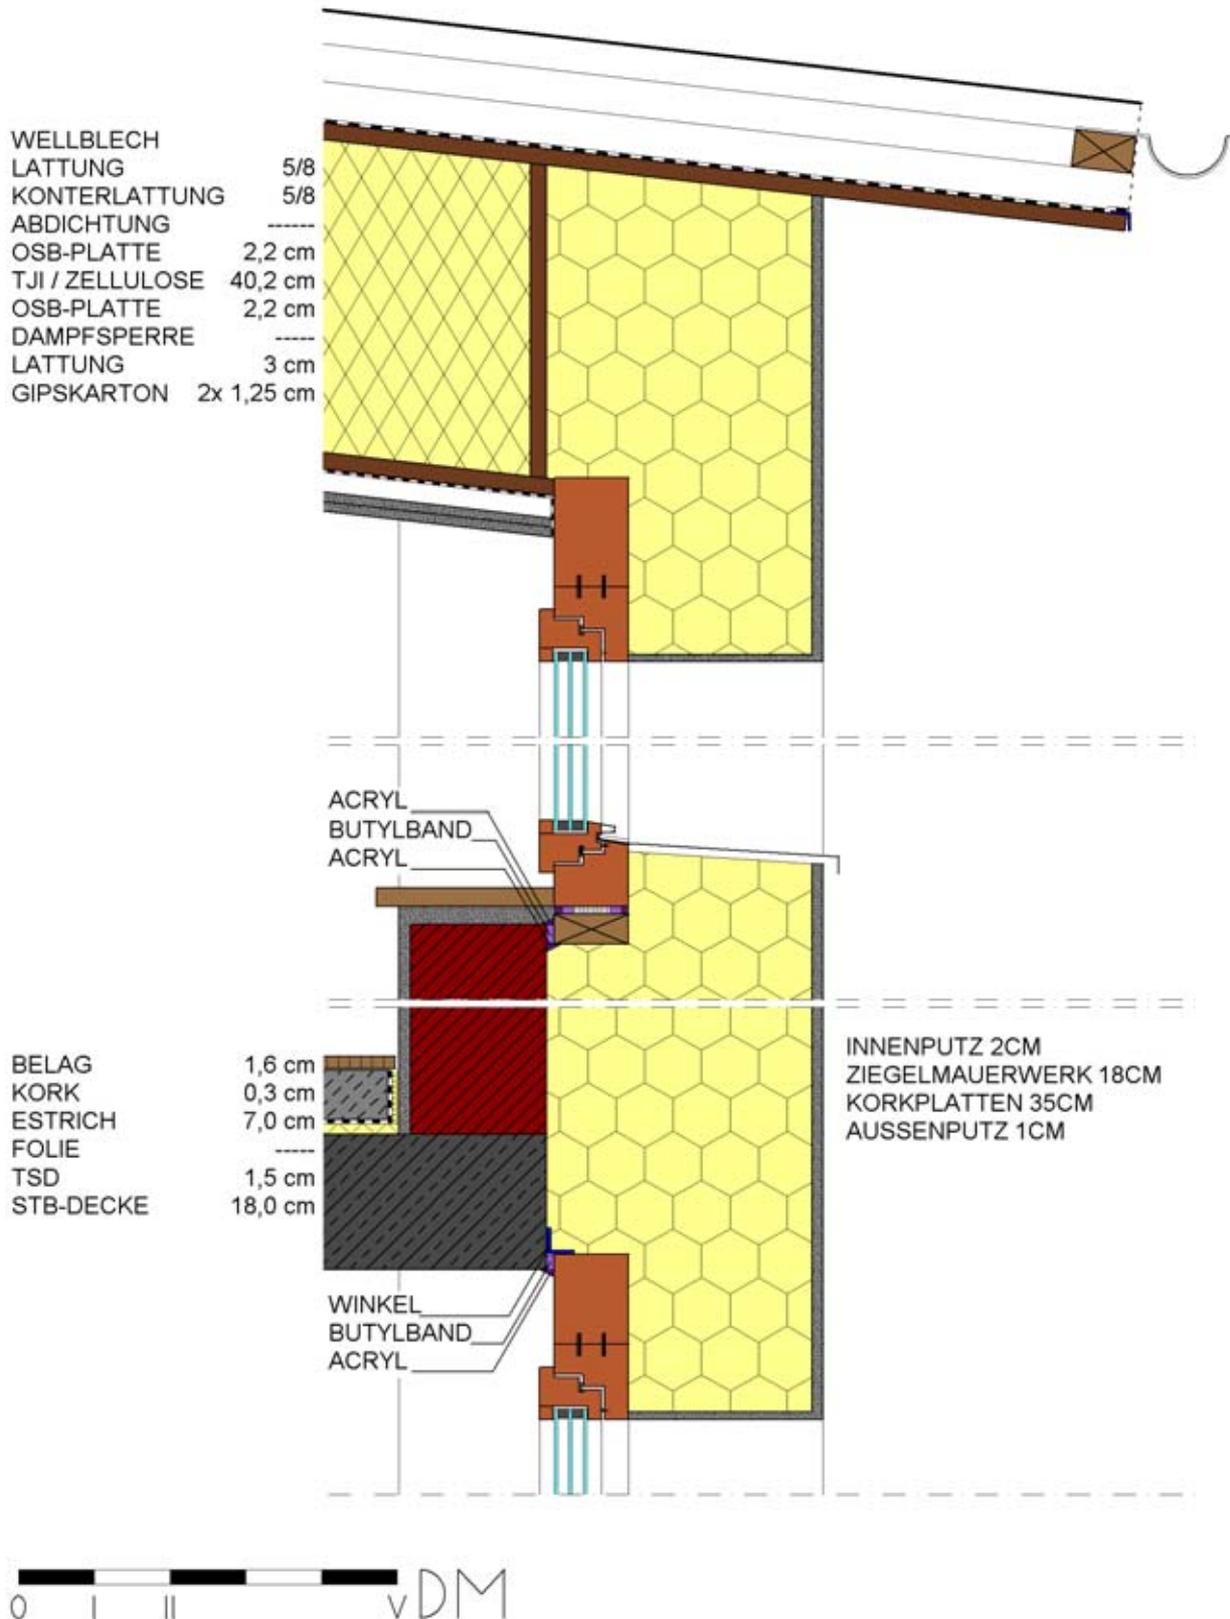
Detail Nordfassade - Decken- und Dachanschluss
